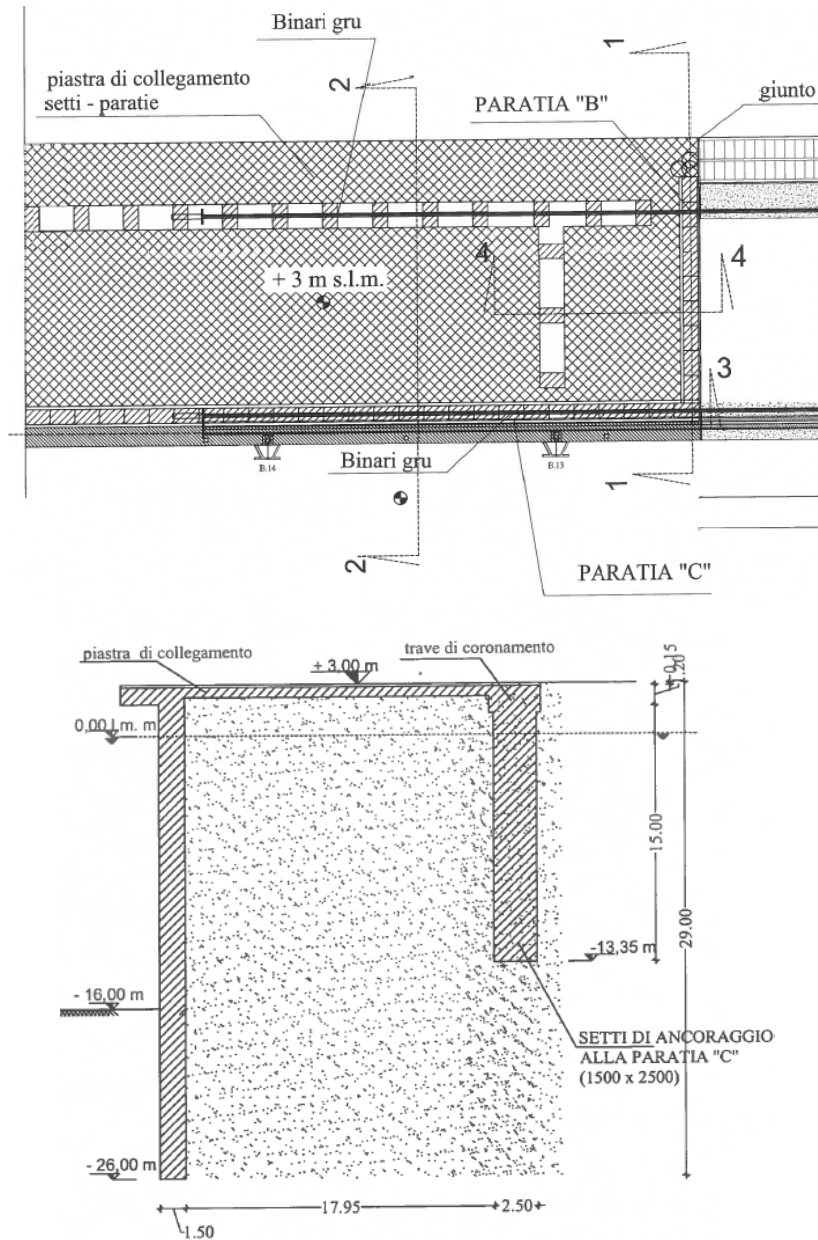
Stralcio planimetrico e sezione tipo (2-2) della banchina nord esistente in prossimità dello spigolo ovest (da Perizia di Variante al progetto appaltato)
